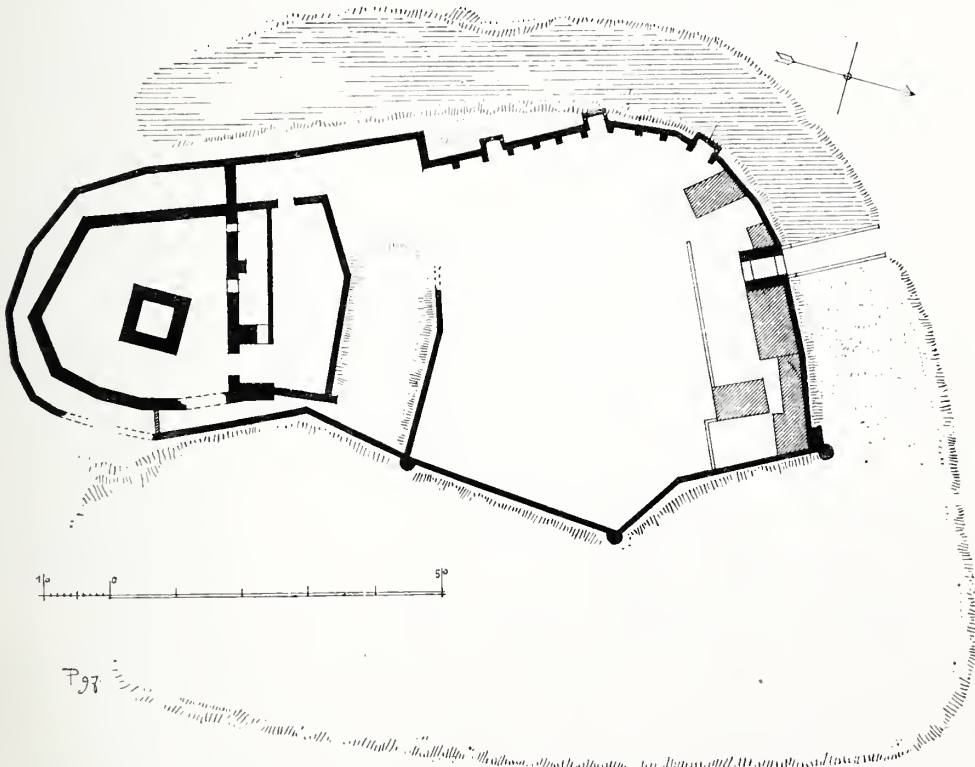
Stotzheim. Hardtburg, Grundrisskizze.
